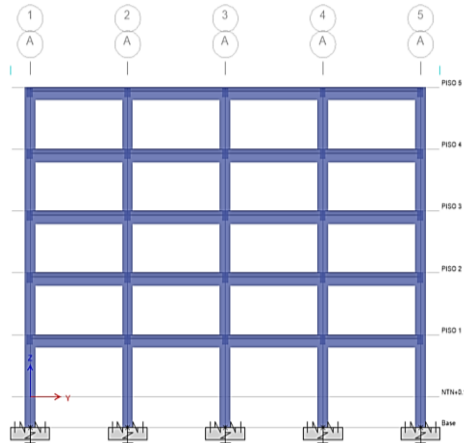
Vista elevación modelo zapata aislada para edificio de 5 pisos
